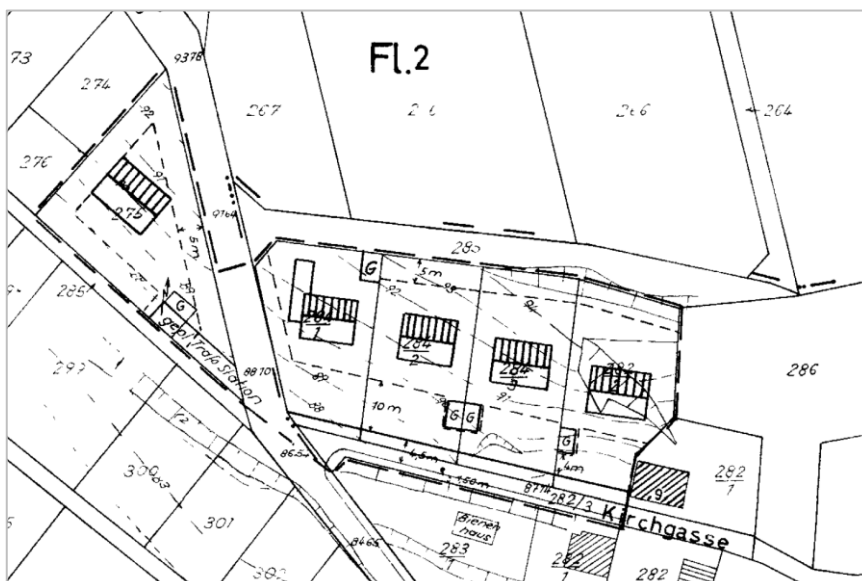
Ausschnitt aus der Planzeichnung B-Plan „Am Darmbruch“ 1964 (o. Maßstab)
